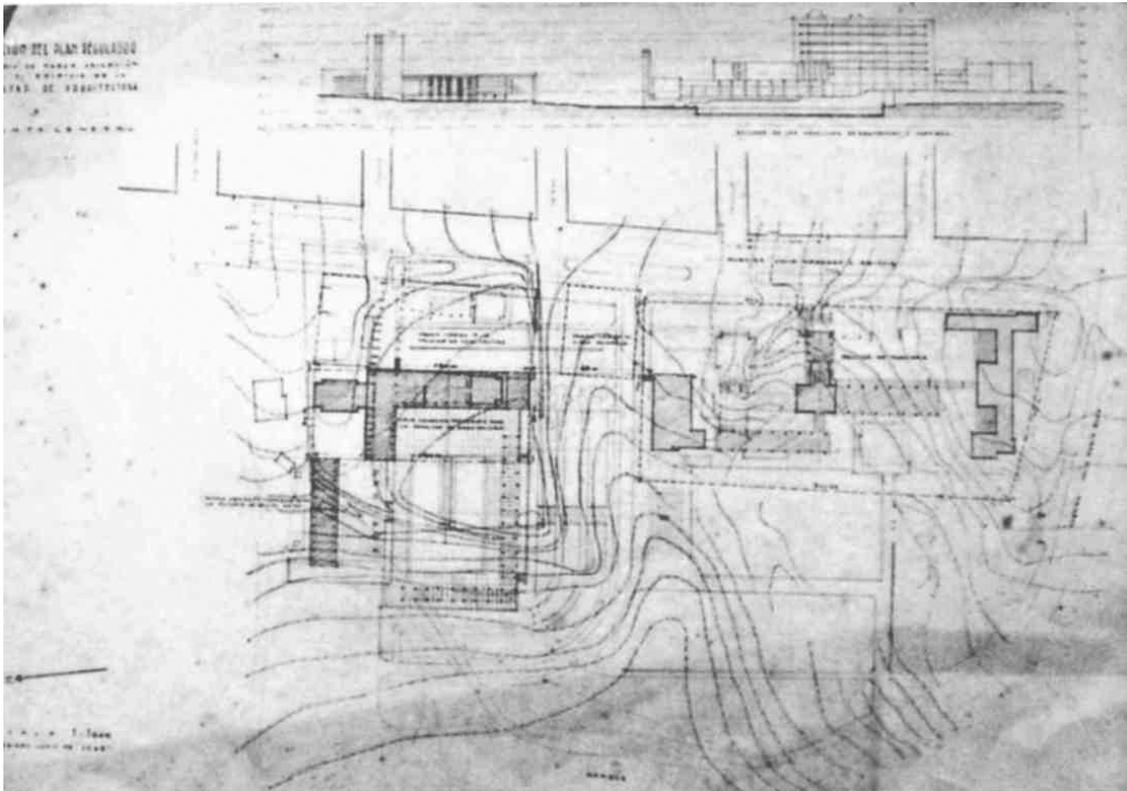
Planta del predio con las Facultades de Arquitectura (izq.) e Ingeniería
